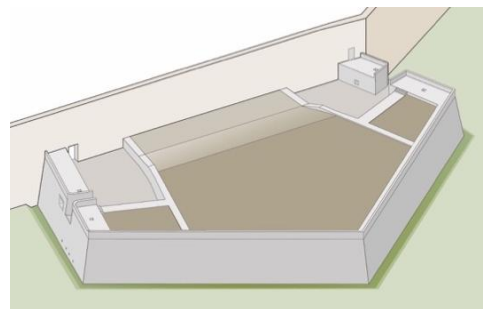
Schema assonometrico dell'ipotetica configurazione assunta dal bastione di Santa Trinità alla metà del XVI secolo (Guarducci Paula)
